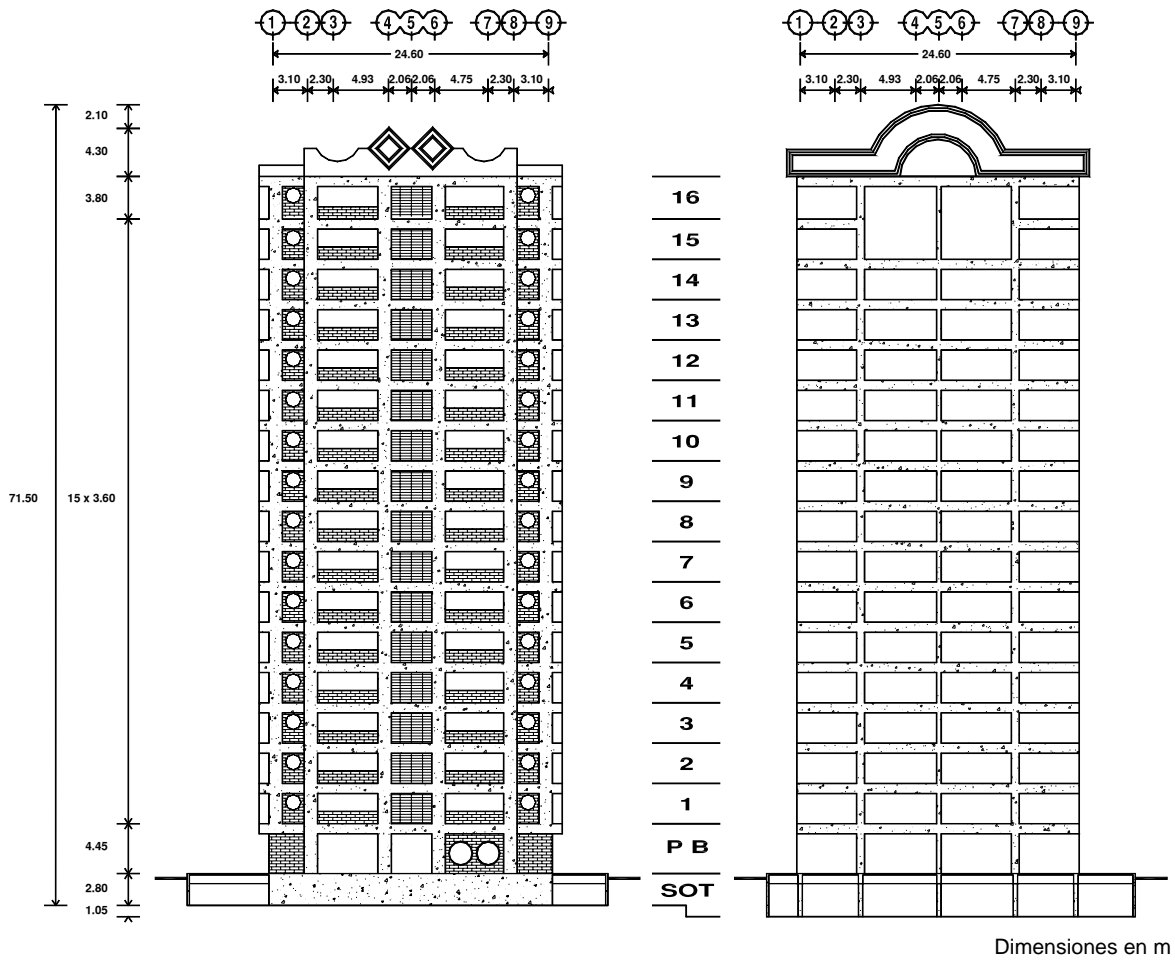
Fachada norte (izquierda) y fachada sur (derecha)
